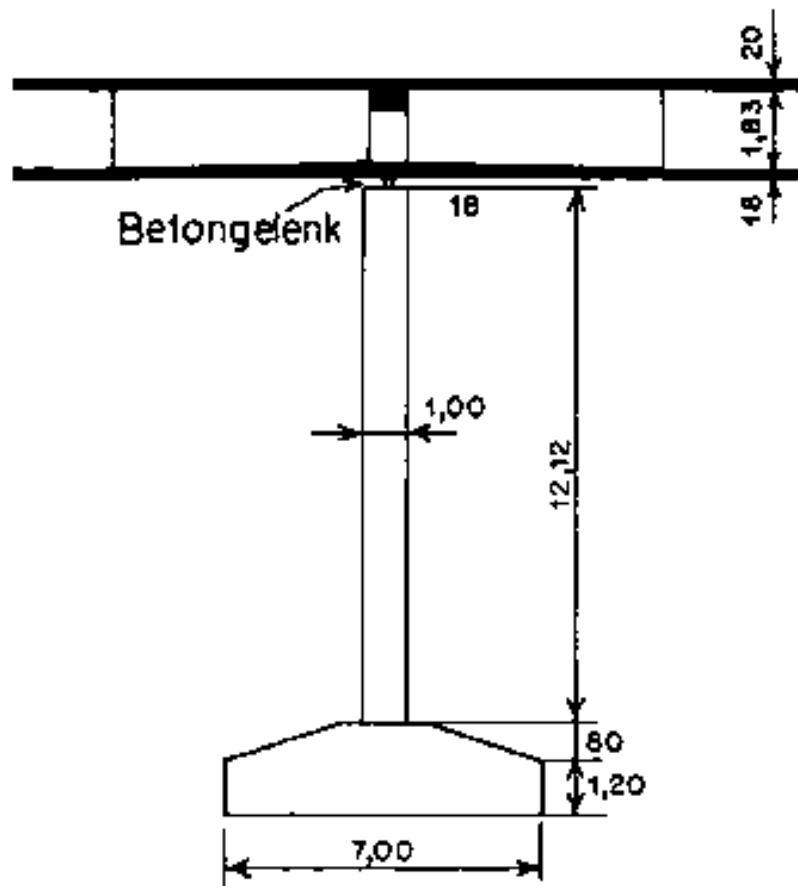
Brückenpfeiler des Hardturm-Viaduktes mit armiertem Betongelenk zwischen Brückenaufbau und Stützenkopf
